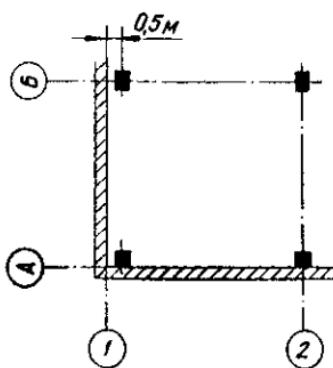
Схема привязки крайних колонн здания к его наружным стенам
